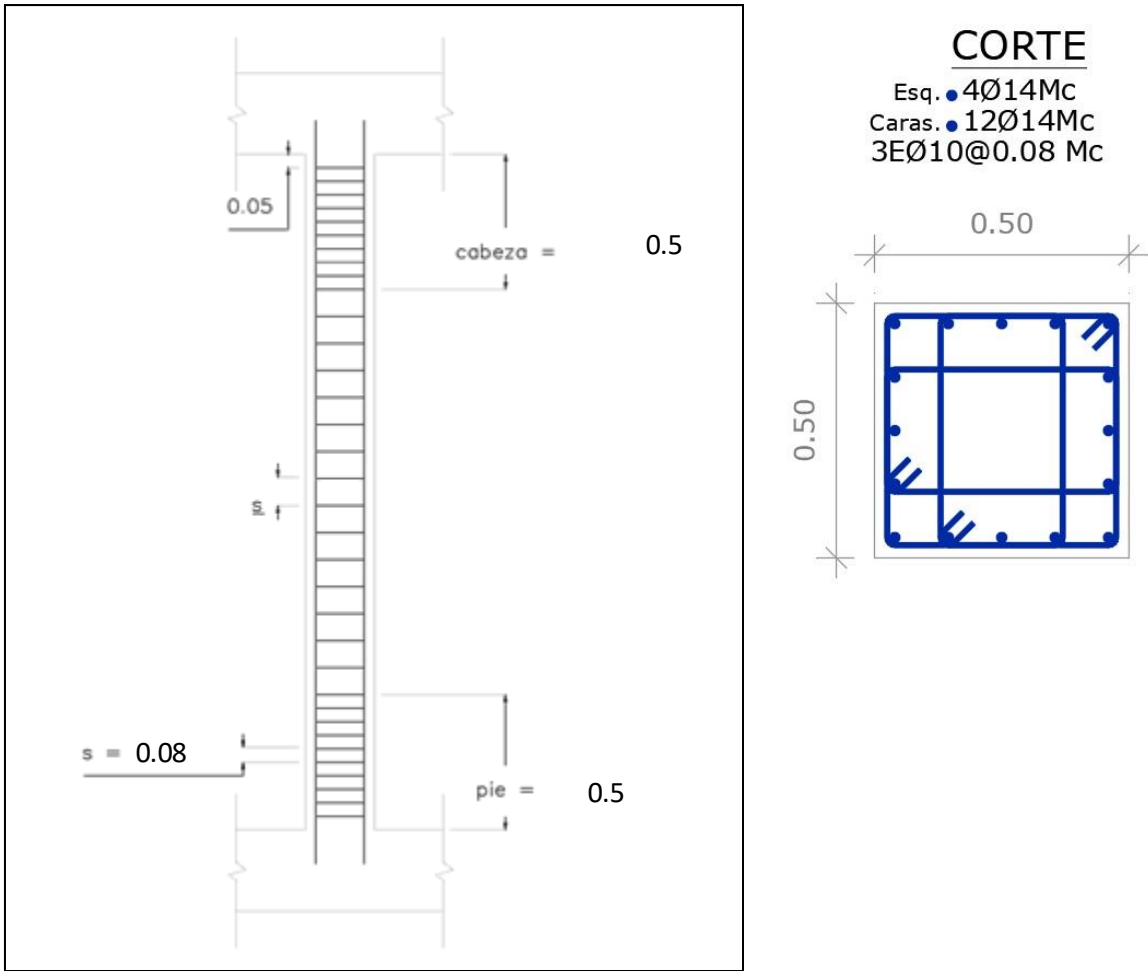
Distribución de Acero de Refuerzo (columnas 45x45)
